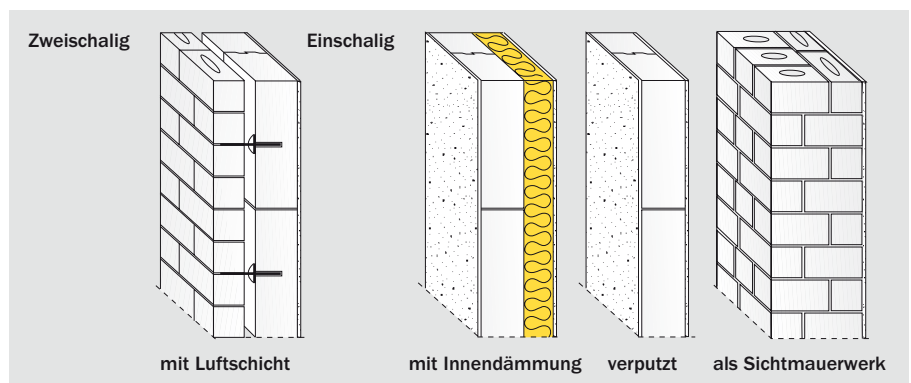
KS-Außenwandkonstruktionen für Sonderfälle
